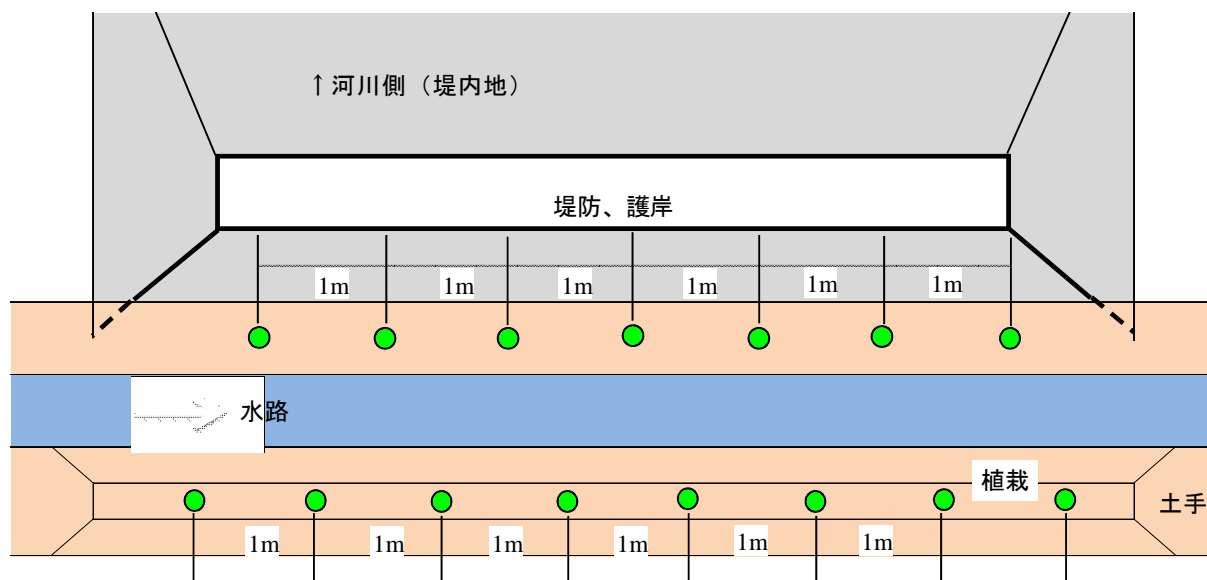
河川構造物沿いの植林計画標準配置図 (タイプ B)
